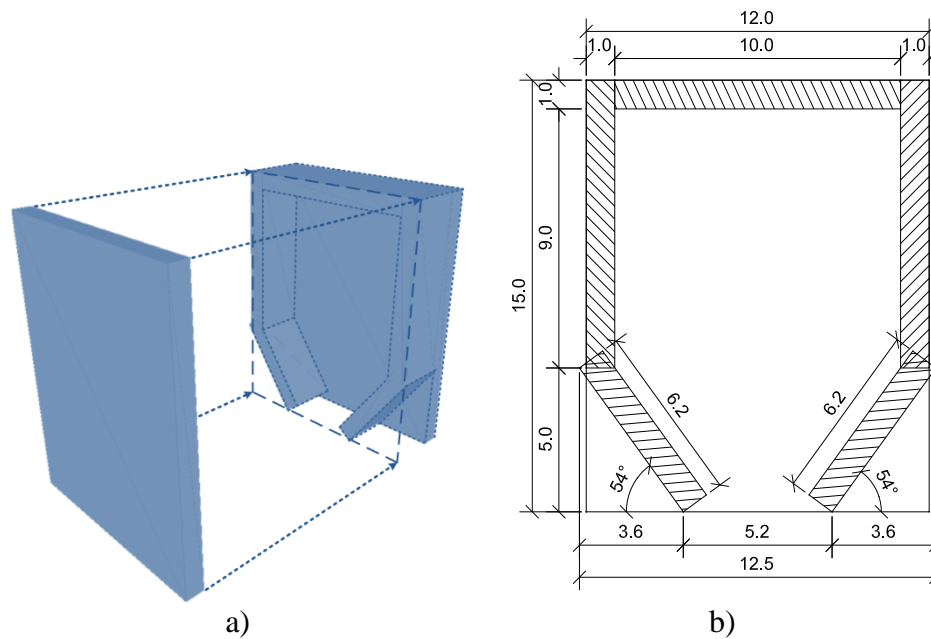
Geometria pâlniei utilizate: a) vedere izometrică; b) dimensiunile acesteia (cm)
